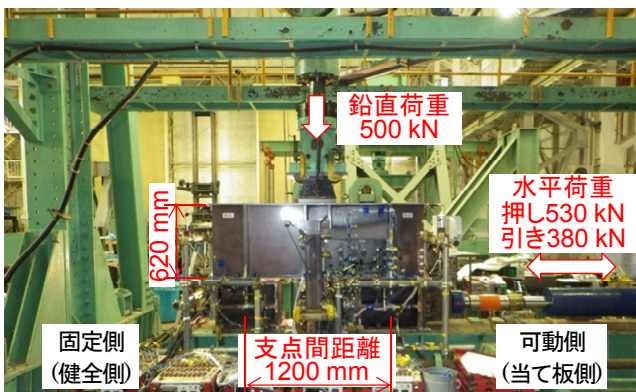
模擬断面欠損部に当て板補強した鋼桁供試体の水平交番載荷試験の状況
